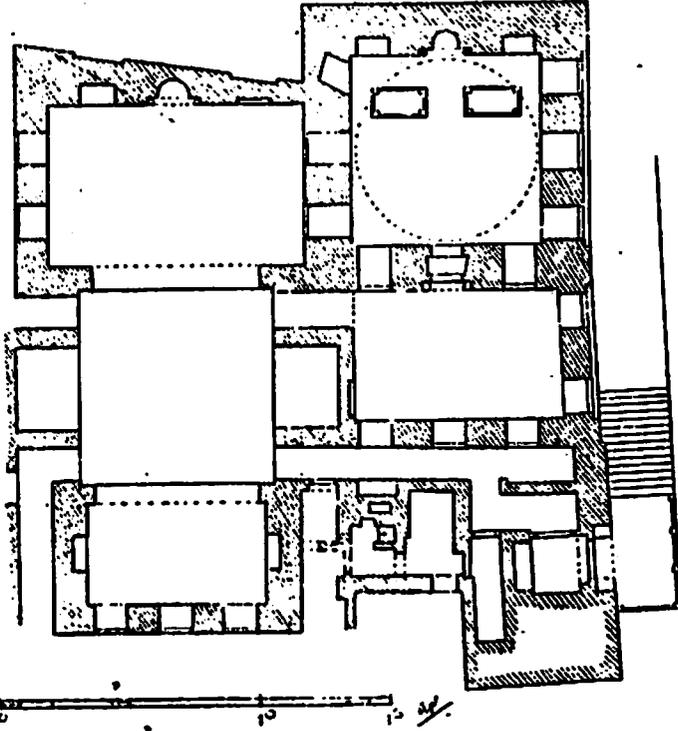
مسقط أفقي المدرسة وقبة حانريك عن كر
